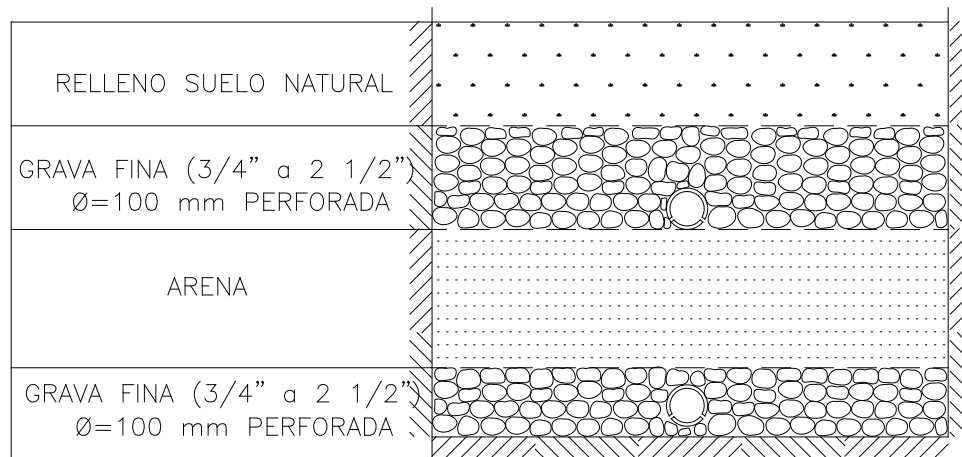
Corte Transversal del Lecho de Infiltración
